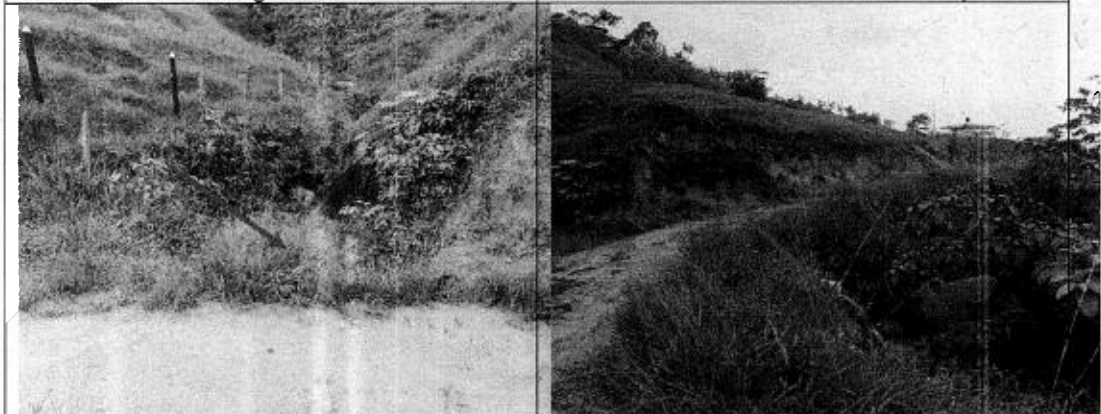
y 15. Tubería empotrada ocupando el cauce de la fuente hídrica.
